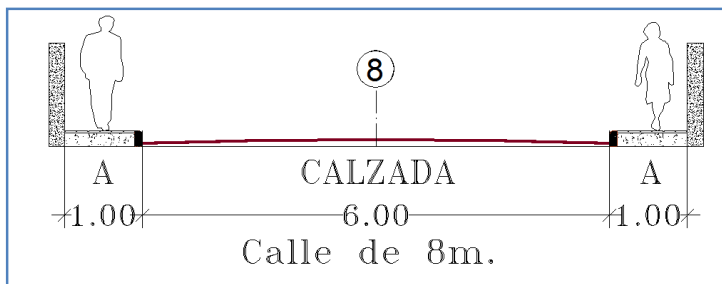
Sección tipo prevista en las NNSS'99 para una vía de 8 metros de ancho.
